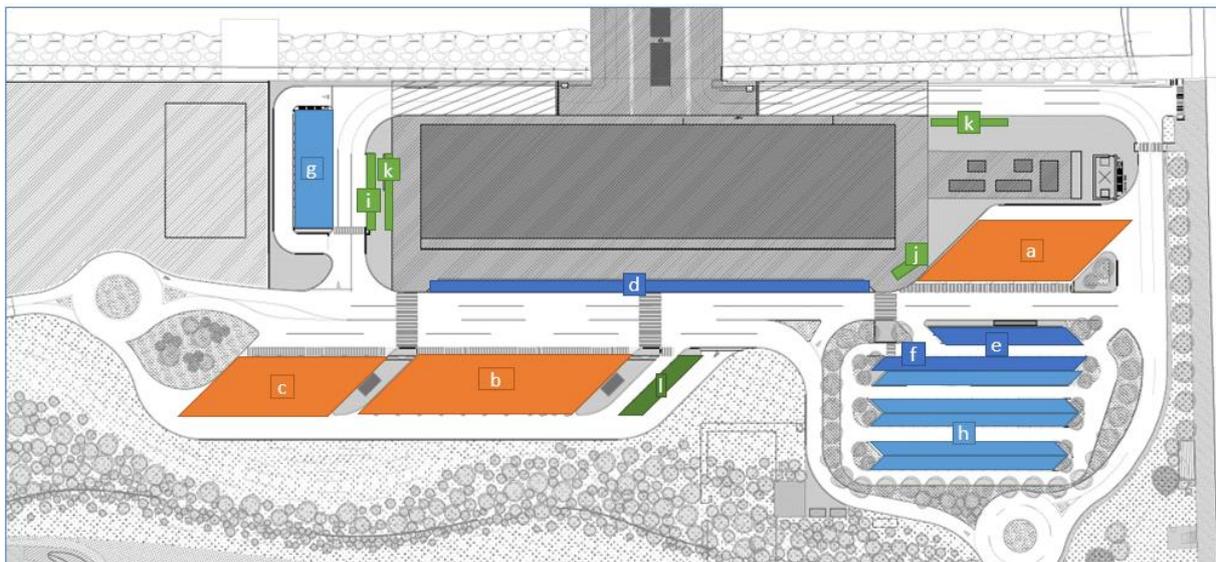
il Layout dei parcheggi nelle aree esterne all'area richiesta in Concessione
